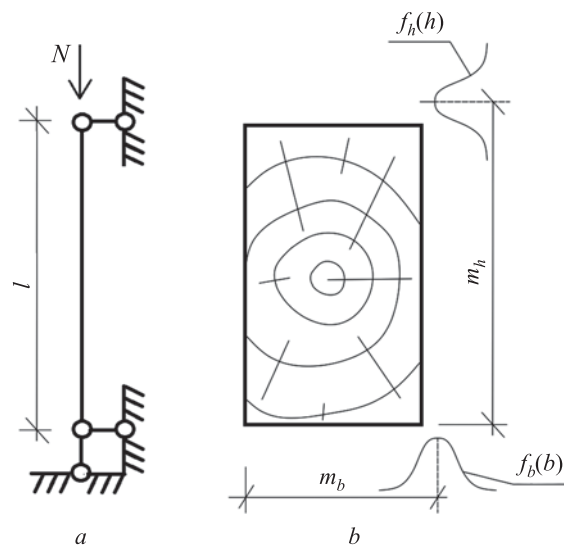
Расчетная схема (а) и поперечный разрез (б) деревянной стойки
